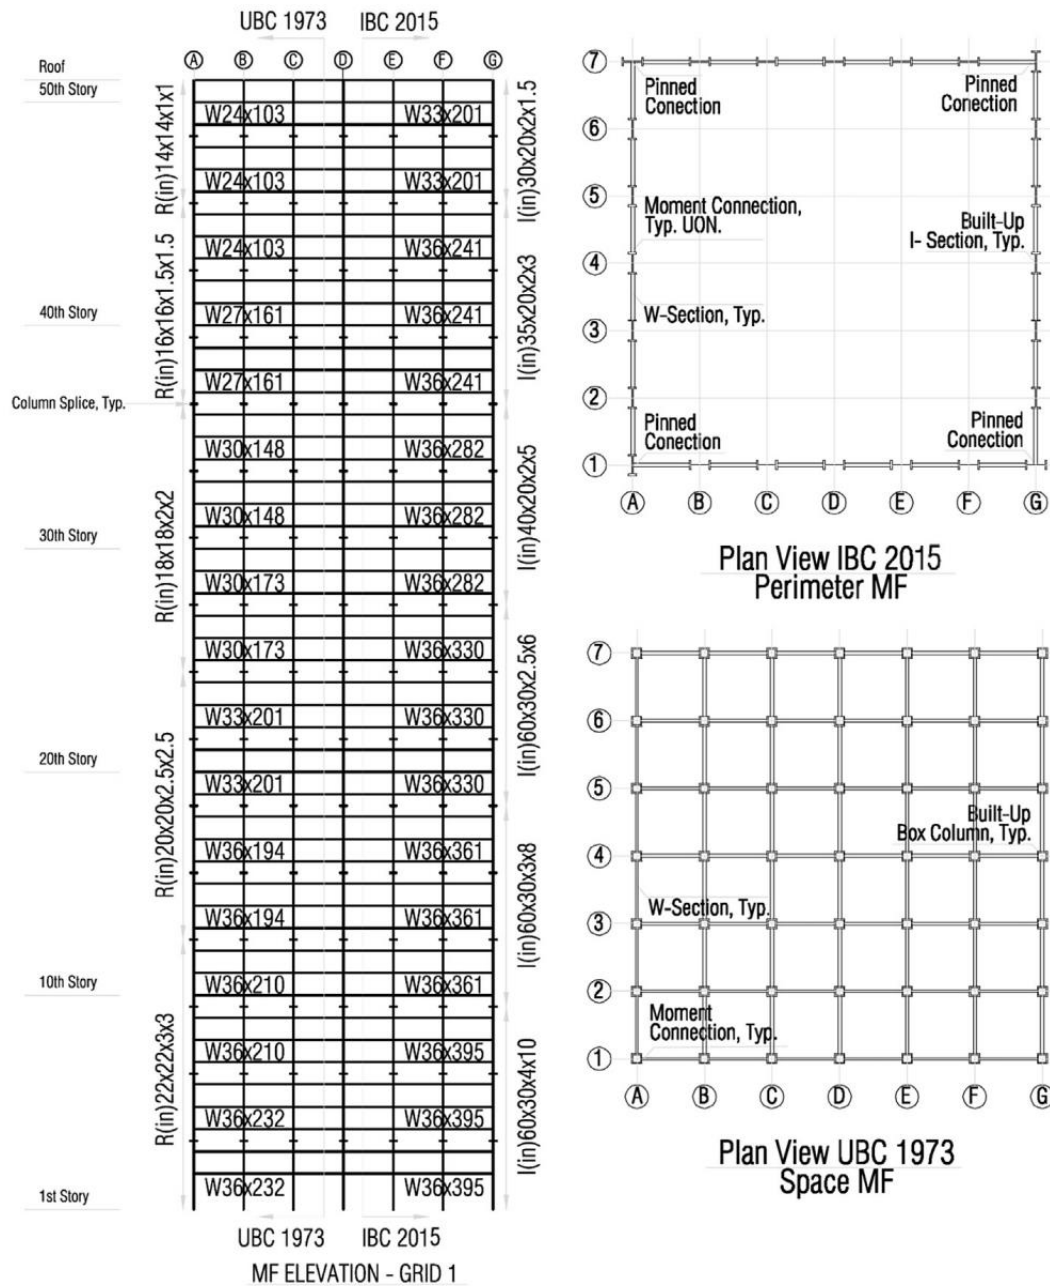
Vista en planta y transversal del edificio de 50 pisos en estudio con secciones de vigas y columnas (Molina Hutt et al. 2019)
